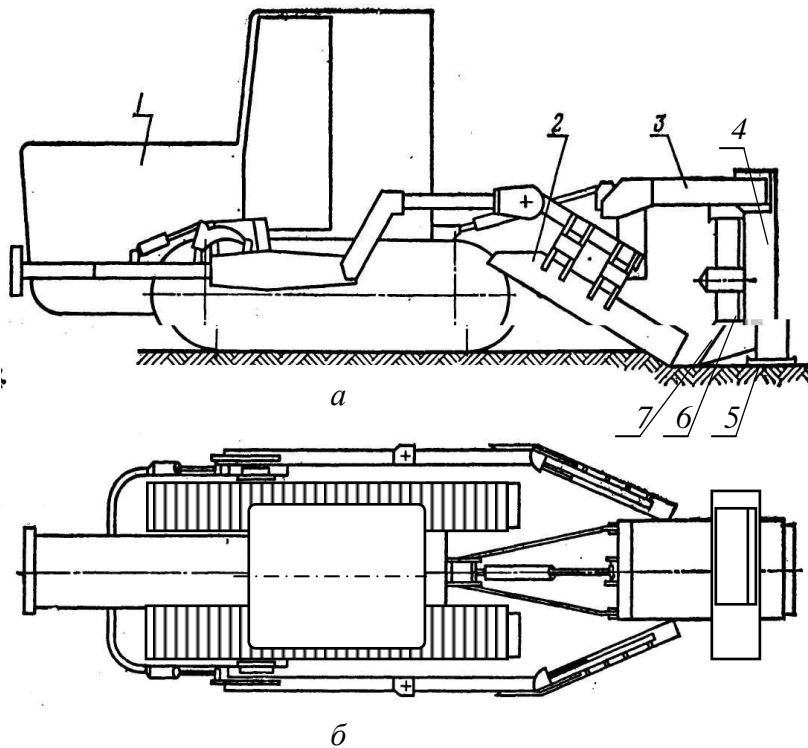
Схема отвально-фрезерного каналаочистителя: а – вид сбоку; б – вид сверху.
